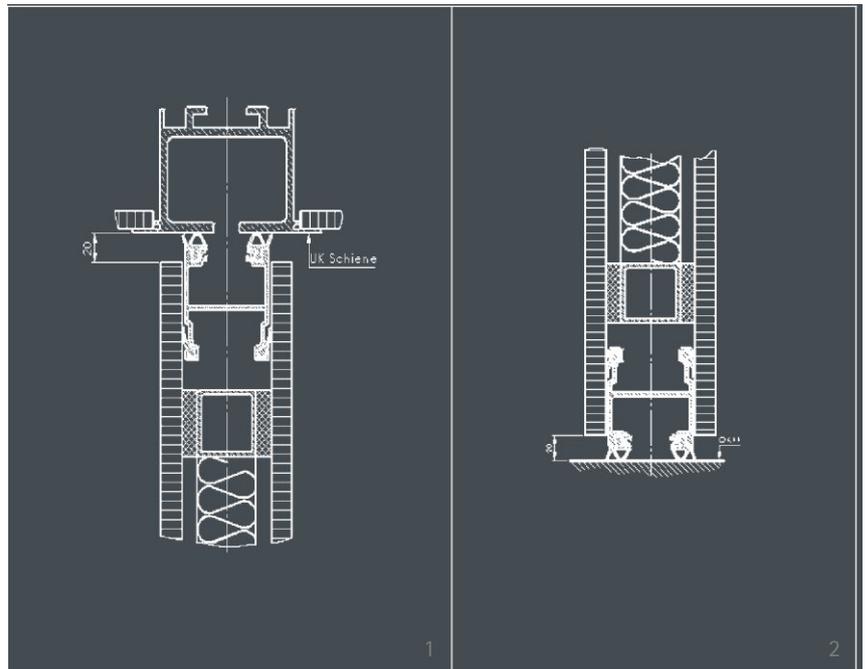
Detail 1 + 2, Decken-, Fußbodenanschlüsse
